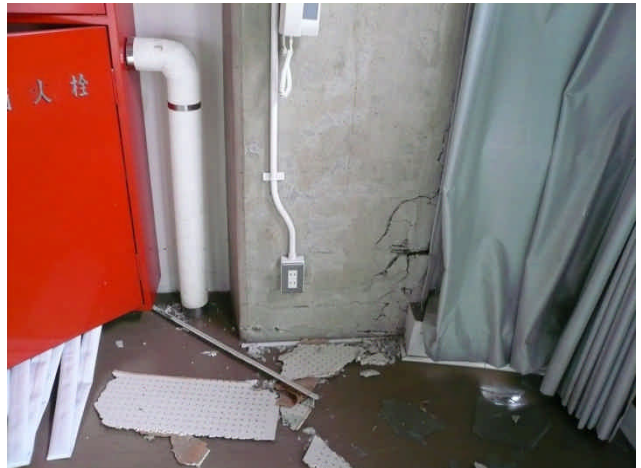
日上市中央体育館の2階外柱の曲げひび割れおよびコンクリート圧壊
